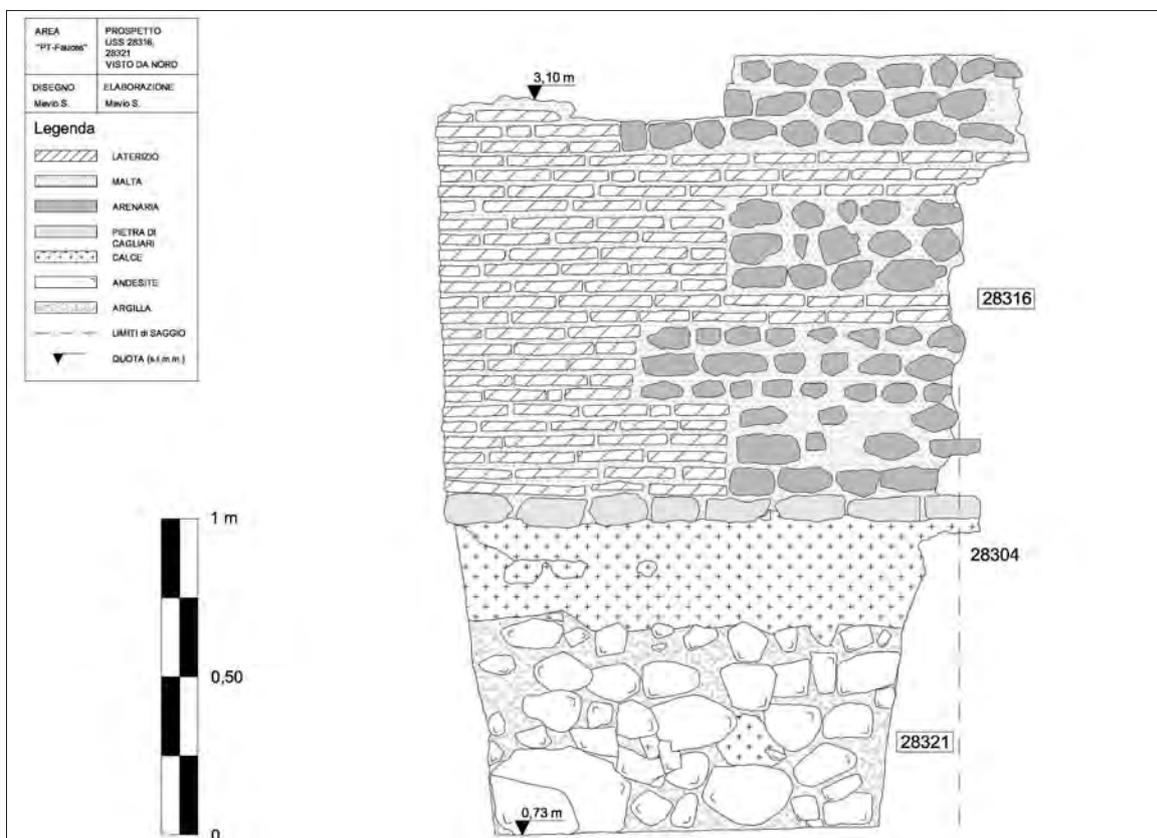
Prospetto delle strutture murarie USM 28316 e USM 28321, perimetrali settentrionali delle Piccole Terme.
